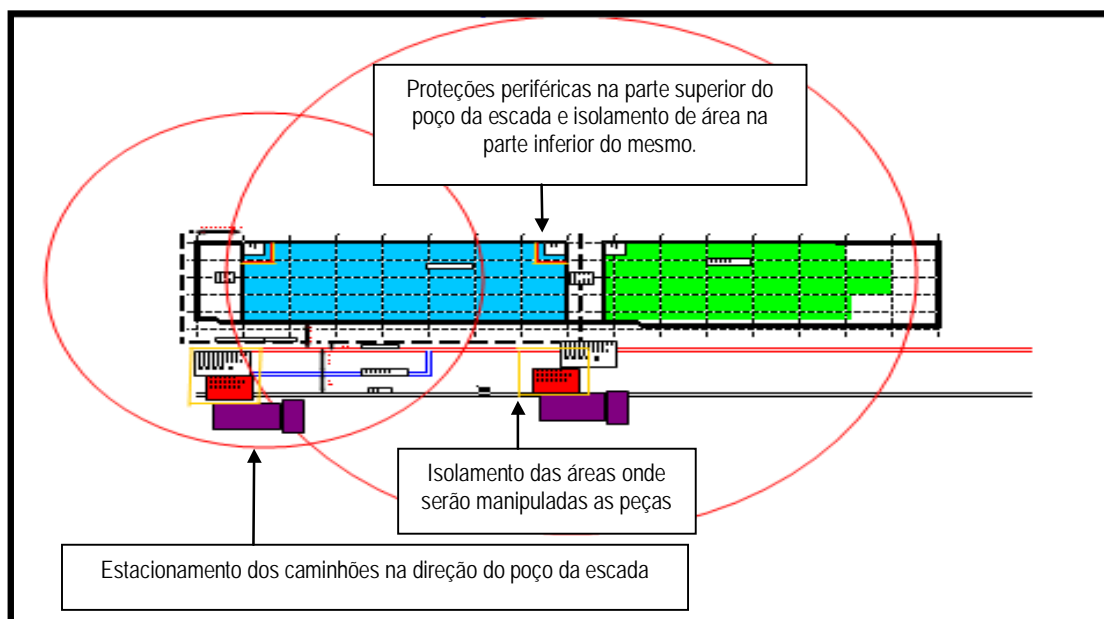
Plano de proteções coletivas em nível do canteiro de obras.
